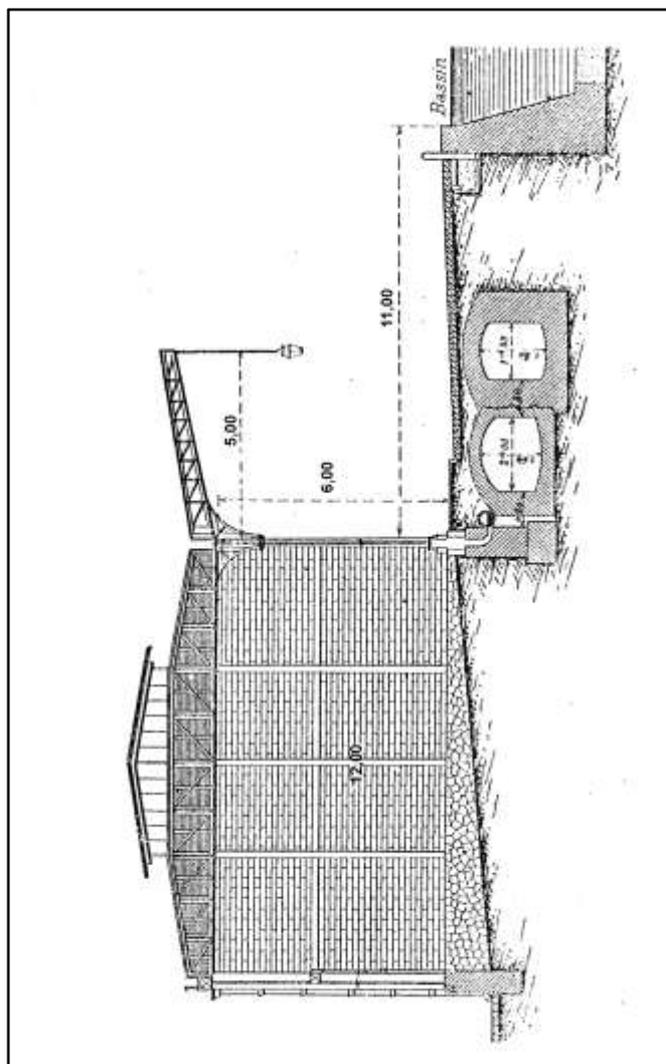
Coupe transversale décrivant les nouveaux hangars du bassin de la Villette, construits en 1880-1881.
